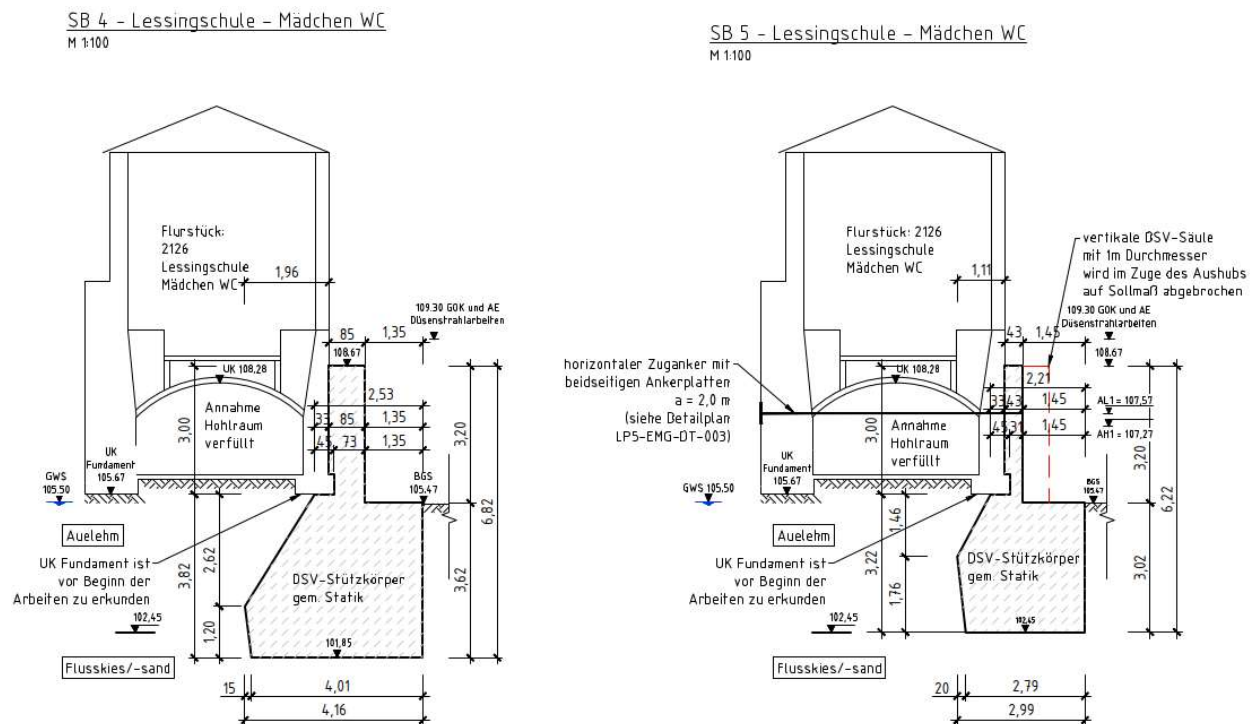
Ausschnitt aus Lageplan und Querschnitte für Düsenstrahlarbeiten [U6]
